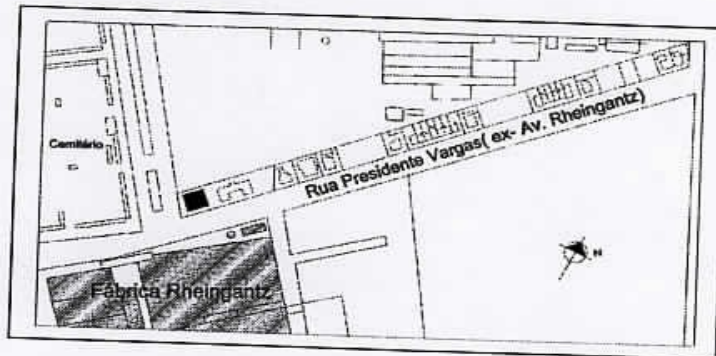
Planta baixa do Grupo Escolar de Luís Leite
